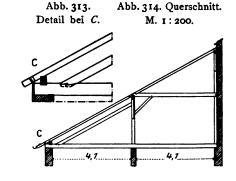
u. 314. Pultdach mit stehendem Stuhl.
